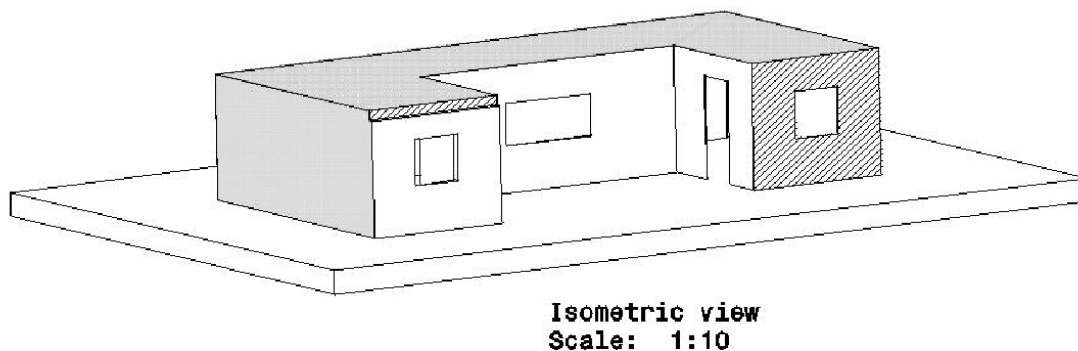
Visión módulo de alojamiento con muro solar en fachada sur lado derecho.
